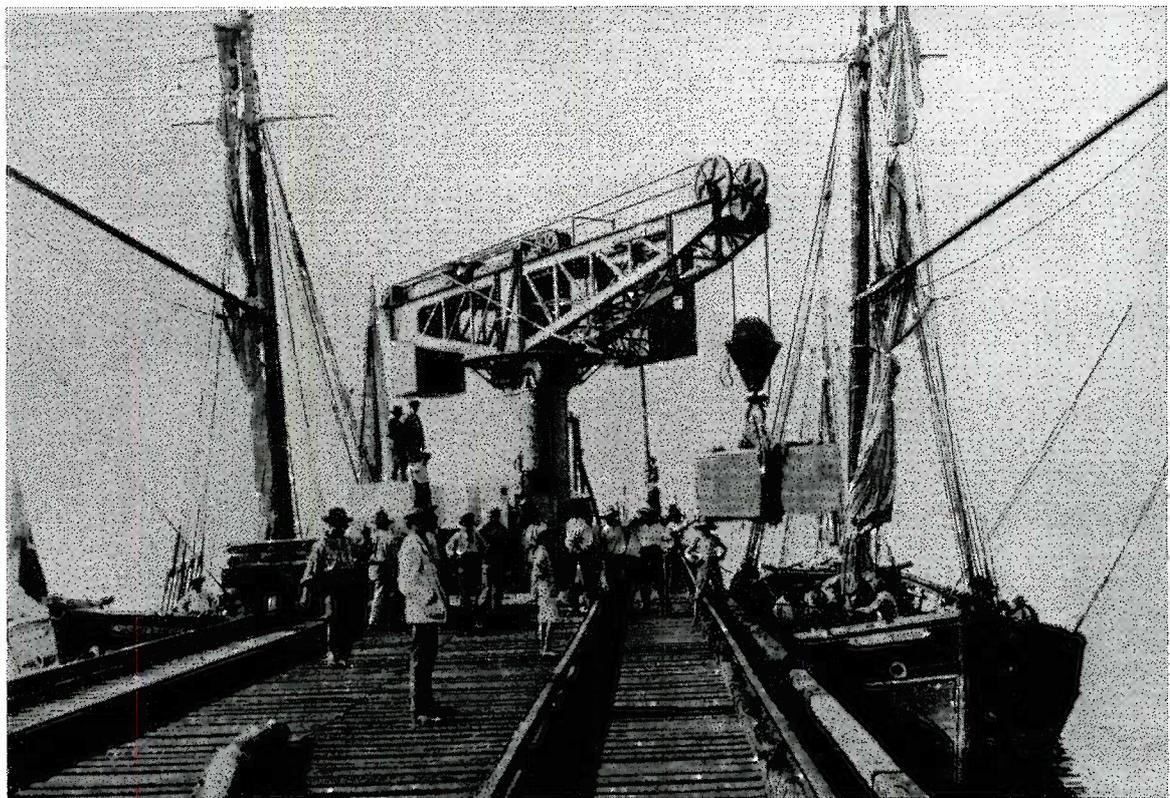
La testata del Pontile Binelli con la potente gru dalla portata di 25 t.
